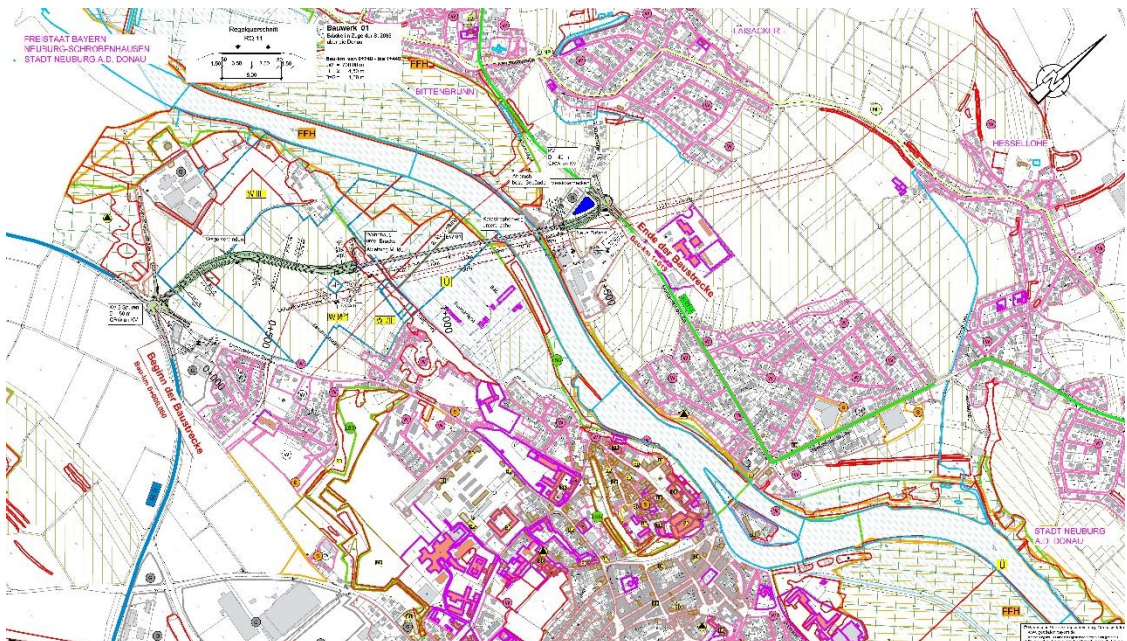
Planfall VI – Westtangente zwischen B16 und ST 2214 (Mittellage)
